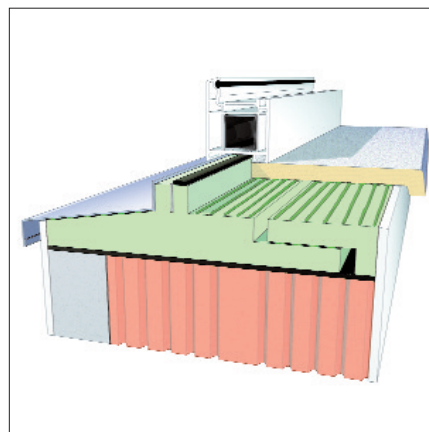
Optimaler unterer Fensteranschluss mit dem illbruck PR003 Fensterbankformteil: schlagregendicht, wärmedämmend, luftdicht.
